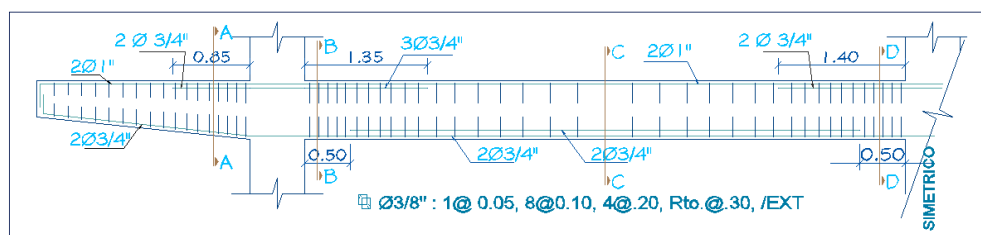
Esquema de la viga principal Pabellón 4J.
